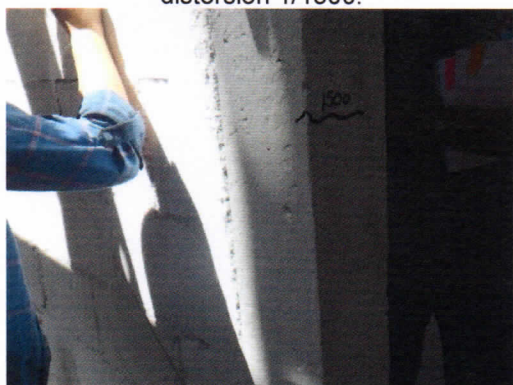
Aparición de primera grieta en la parte central de la columna Oeste para una distorsión 1/1500.
